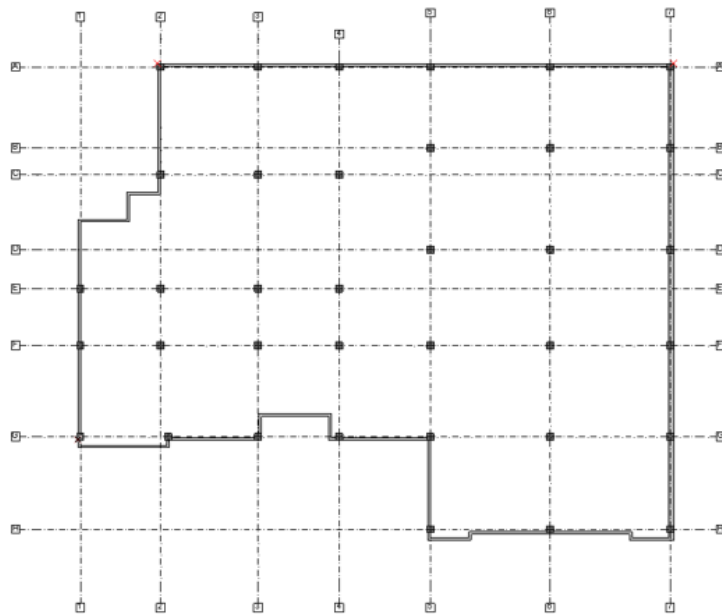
Inicio de modelado paredes exteriores, columnas y ejes. Elaboración: Del autor.
